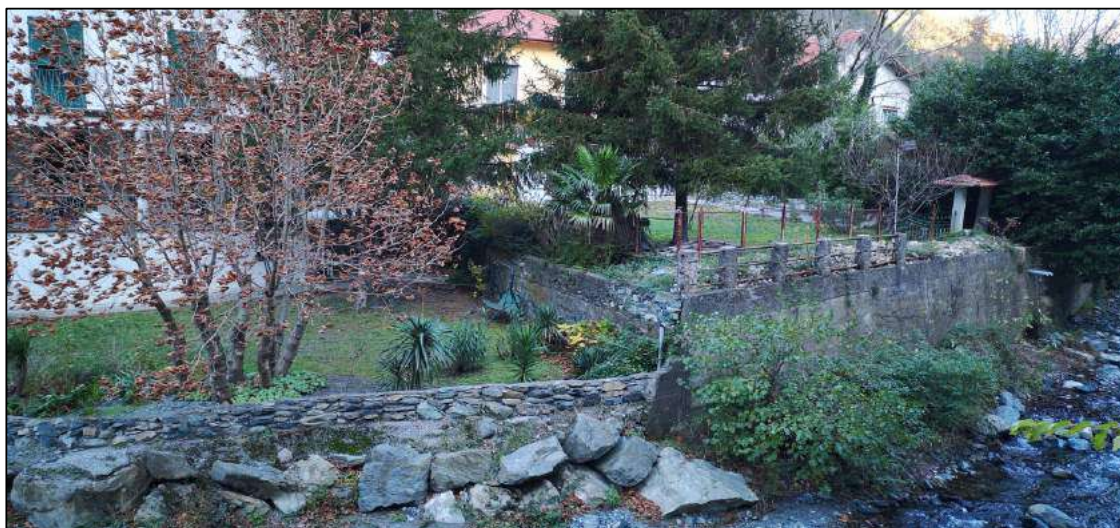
sponda destra vista dalla sponda sinistra: si nota il gradone presente in corrispondenza dell'ultimo tratto arginale, in prossimità dell'ultima casa in sponda destra.
